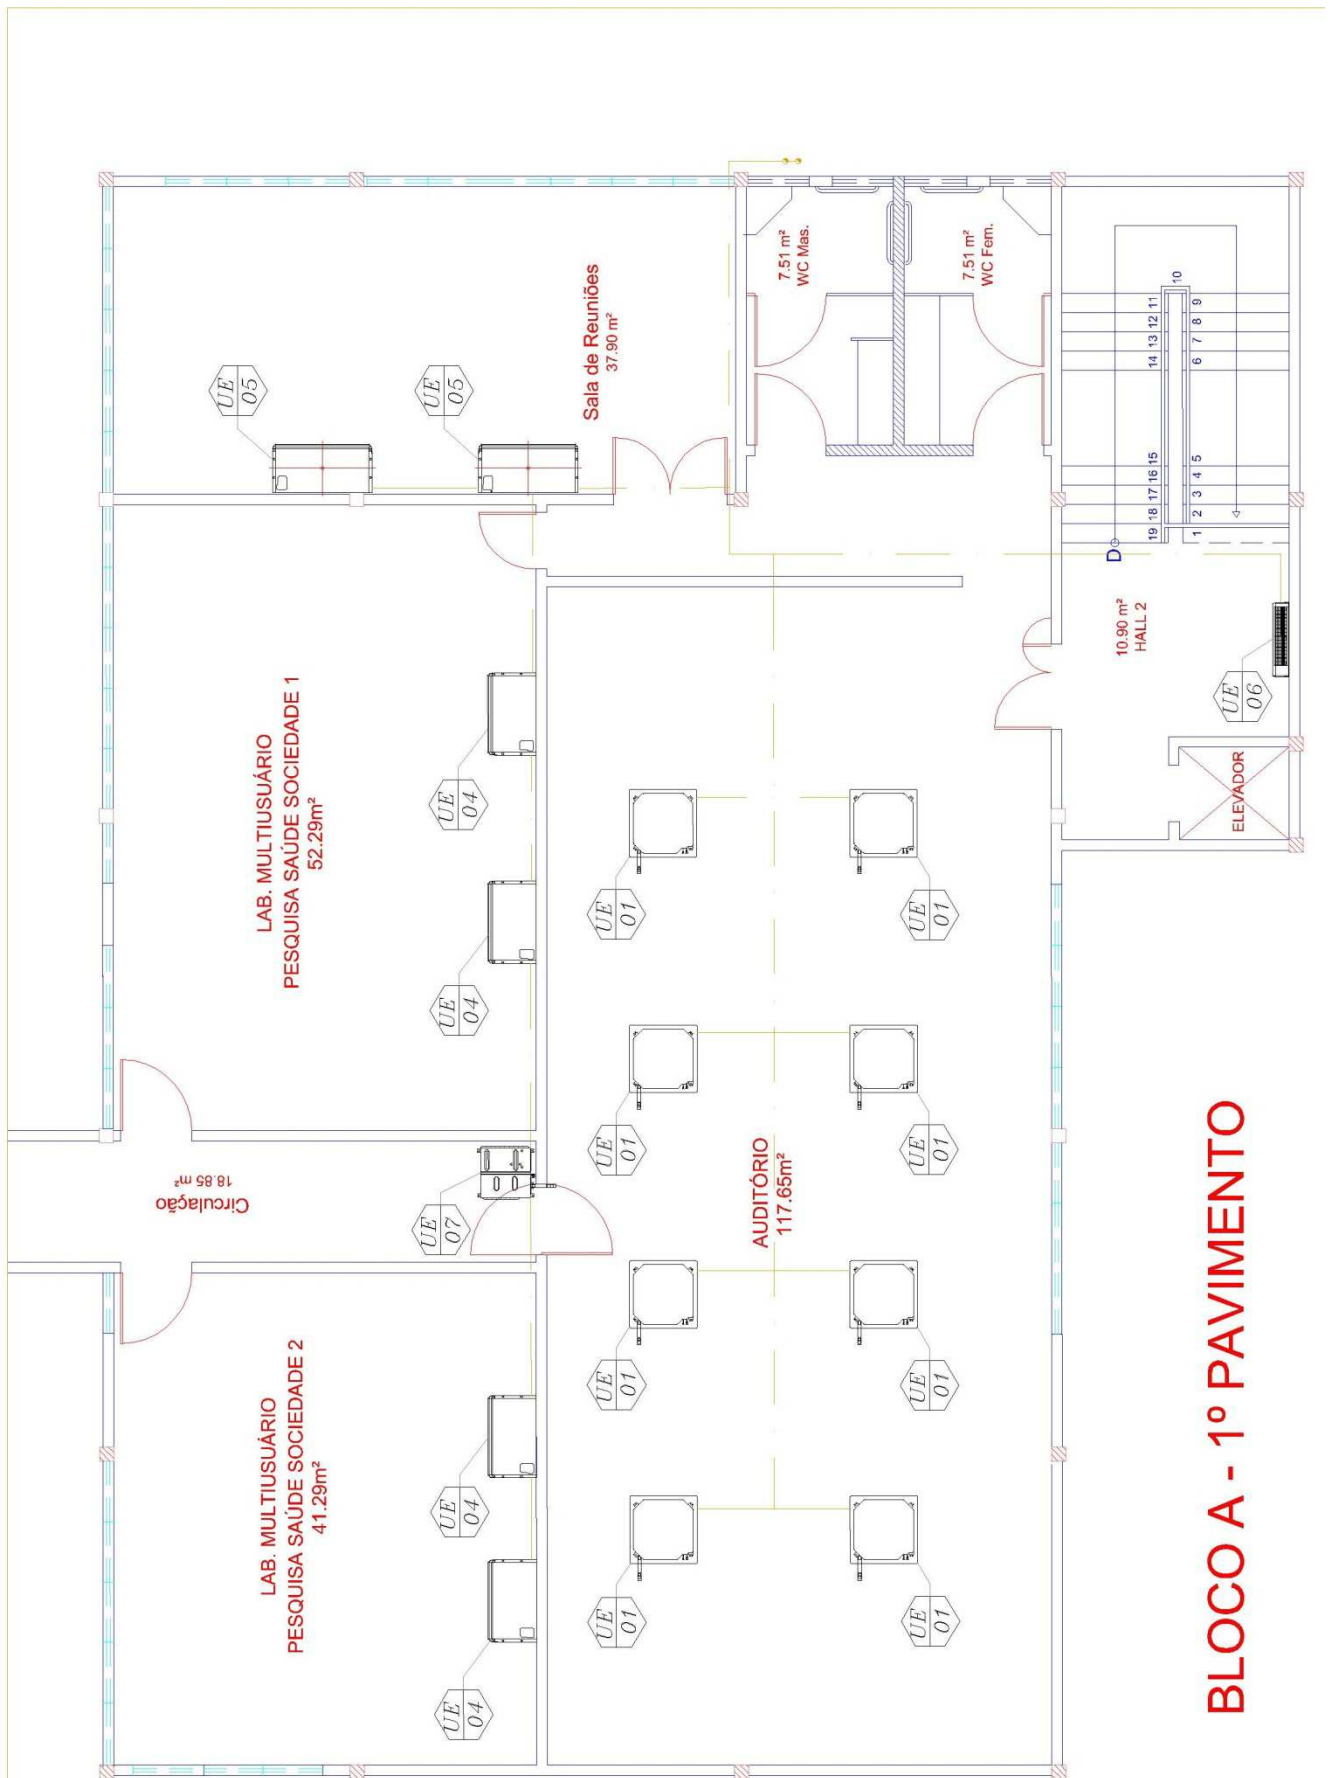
Disposição das unidades no Bloco A – 1º Pavimento
